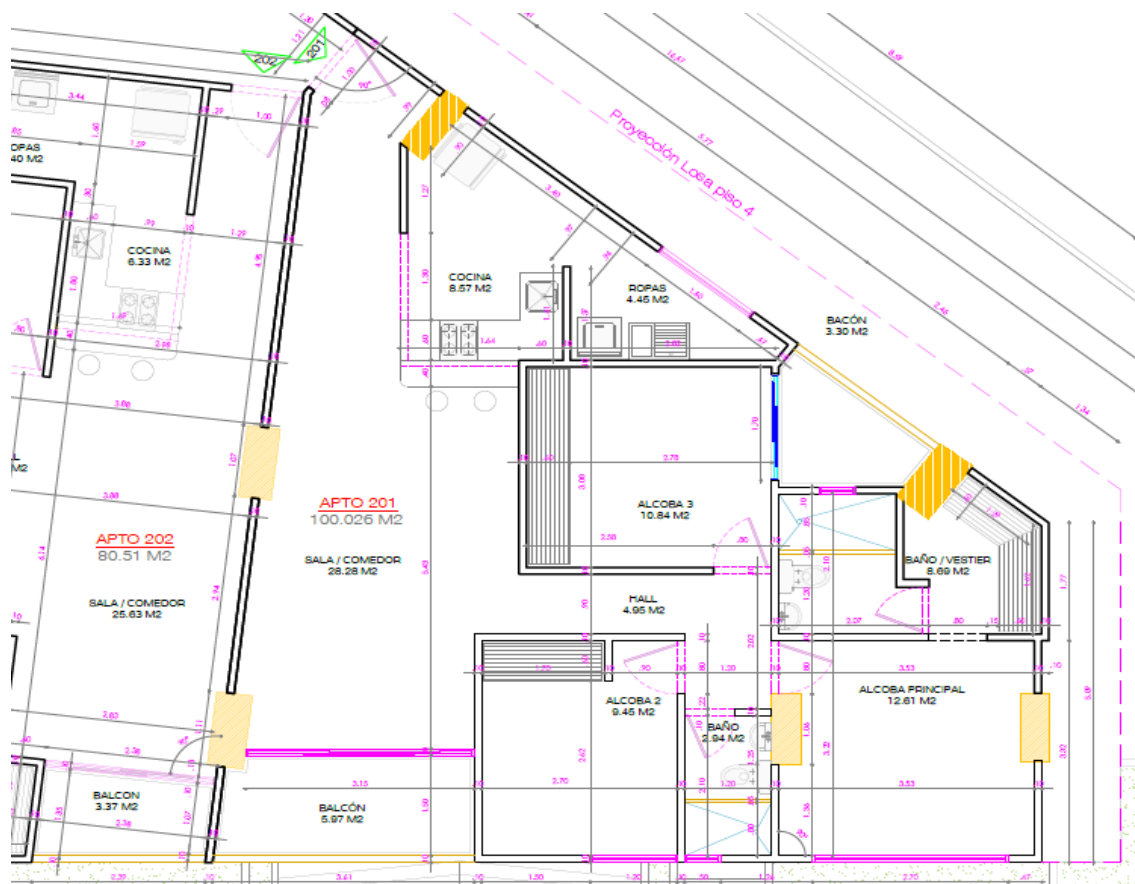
Planta Arquitectónica apartamento tipo 1A (Pedrozo Perez)
